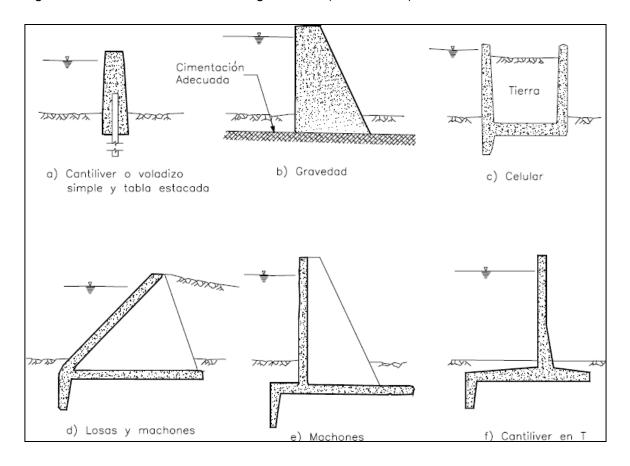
Tipos de muros de encauzamiento. (Maza, 1996)
